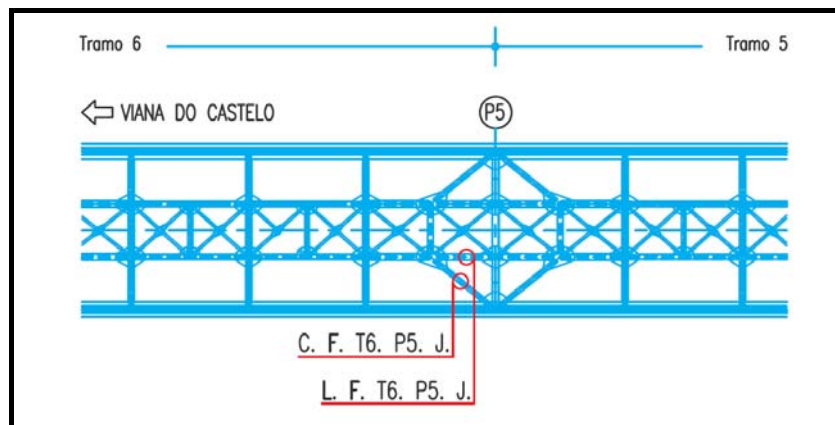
Localização em planta das secções instrumentadas com extensómetros
